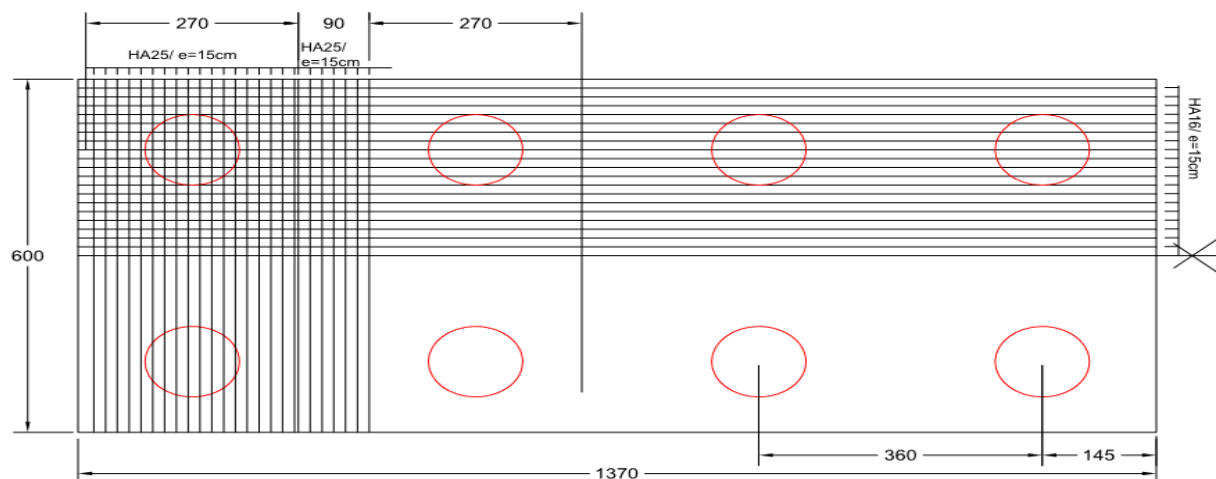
Plan de ferrailage de la nappe inférieure
